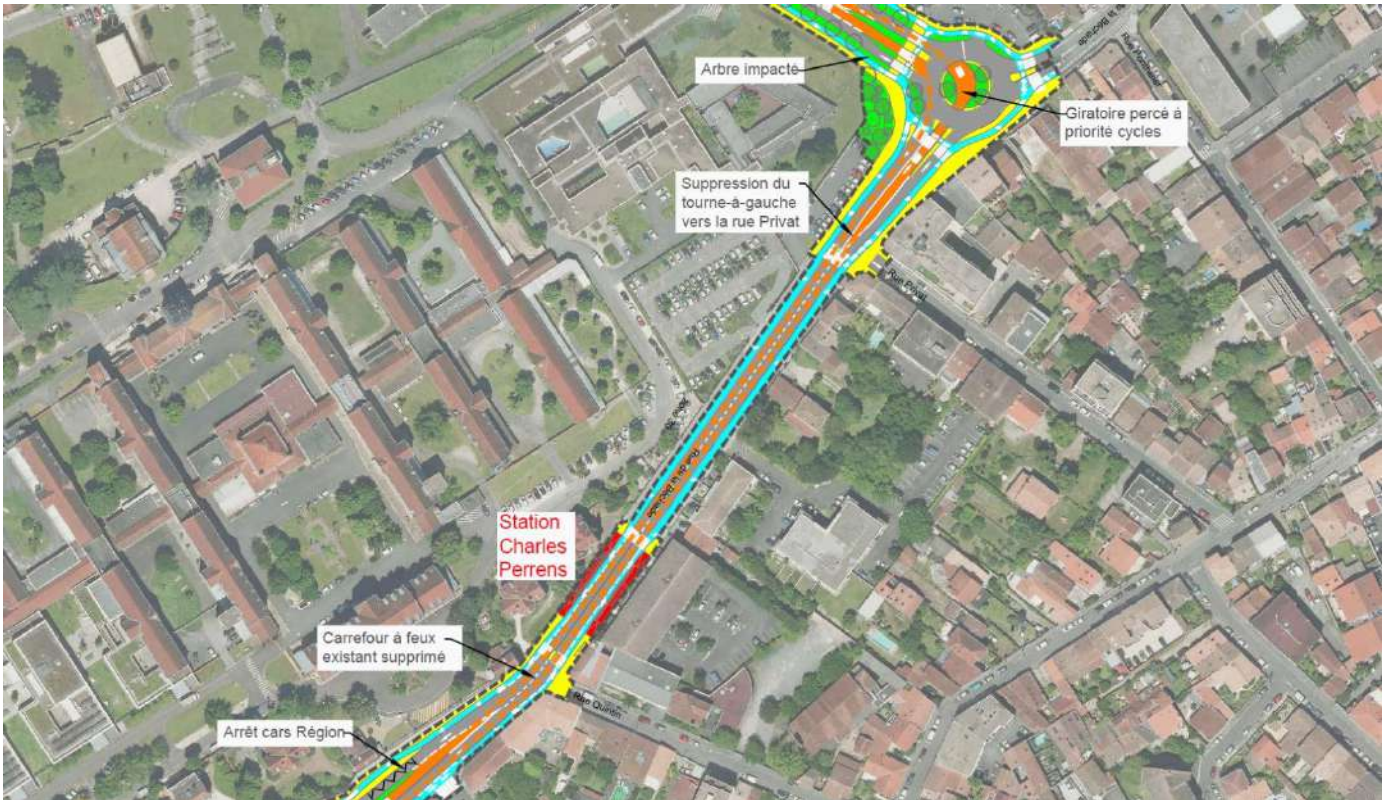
Extrait de plan AVP-Insertion sur la rue de la Béchade
